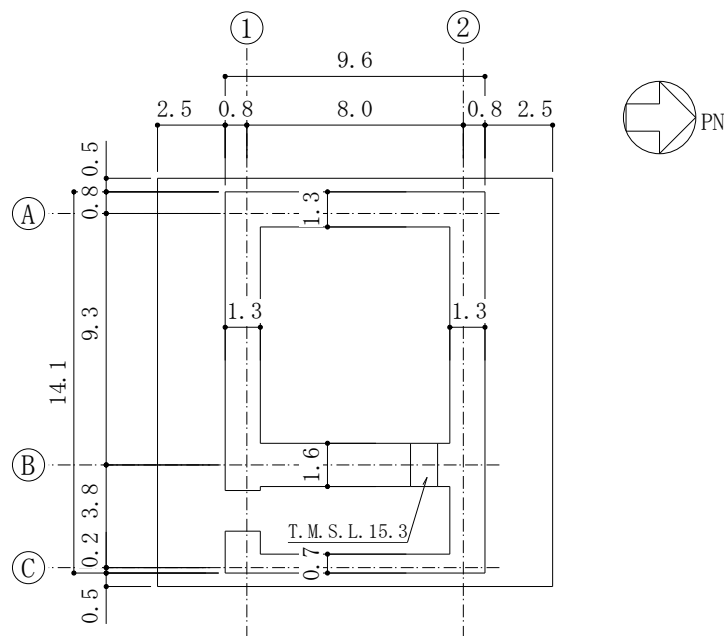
格納容器圧力逃がし装置基礎の概略平面図 (T.M.S.L. 12.3m) (単位 : m)
